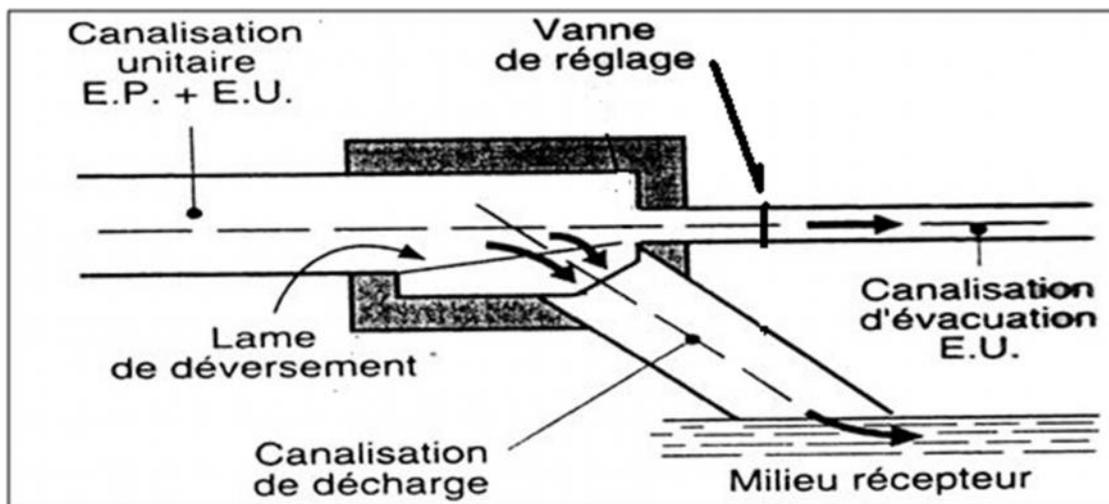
schéma d'un déversoir d'orage type latéral.
